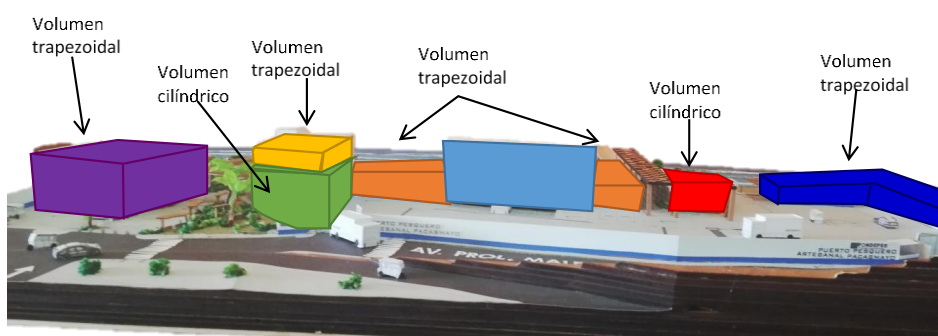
Volumetría. Fuente: Andrade y Carrera (2019)
